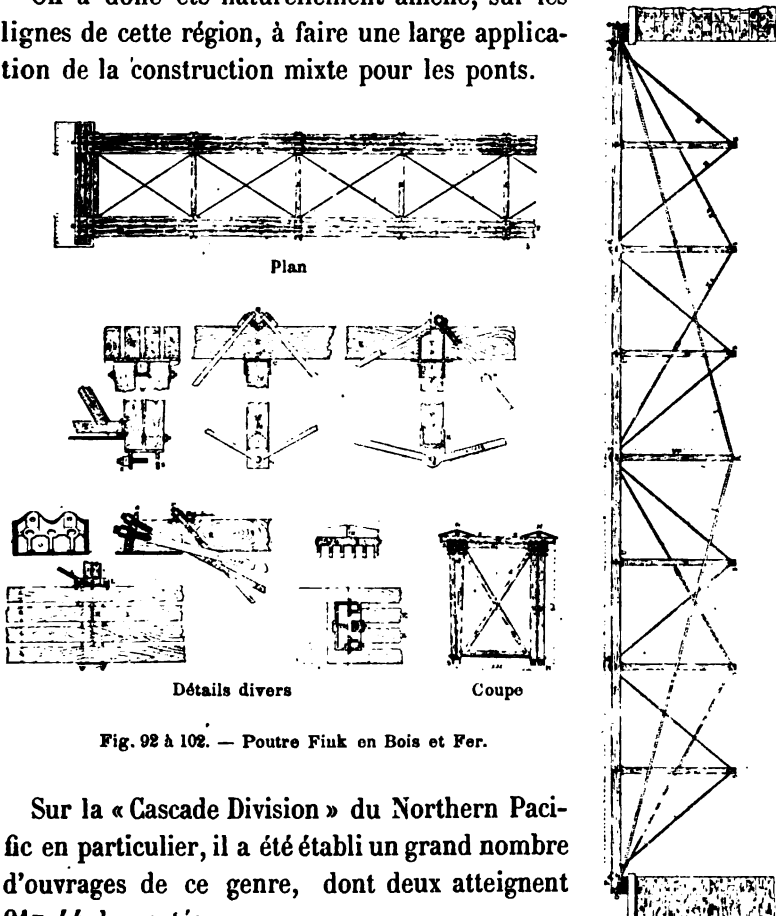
à 102. — Poutre Fiuk en Bois et Fer.
